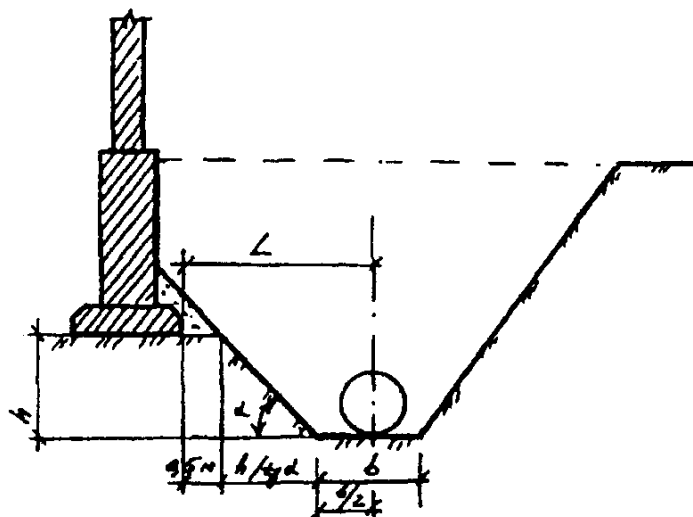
Схема визначення відстані між фундаментом будівлі та водовідводним трубопроводом
